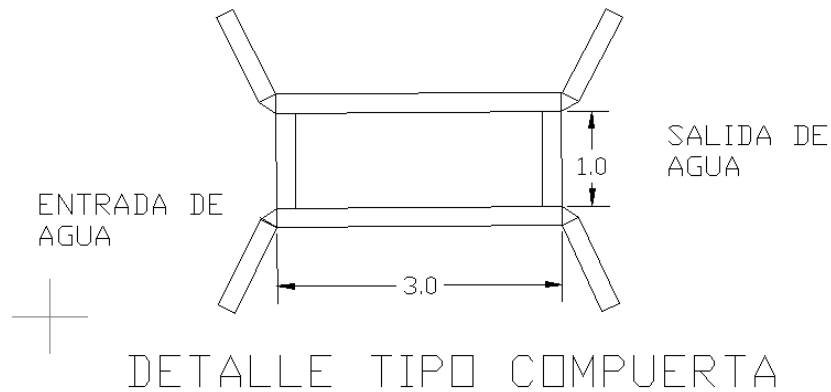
Tipo de estructura de las compuertas para la entrada y descargas de las aguas del estanque
